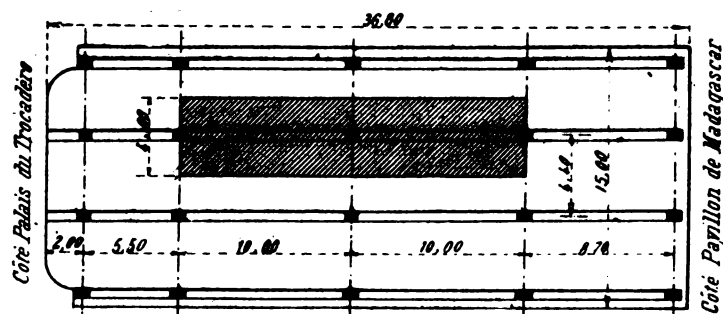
Plan schématique des poutres principales de la passerelle.
